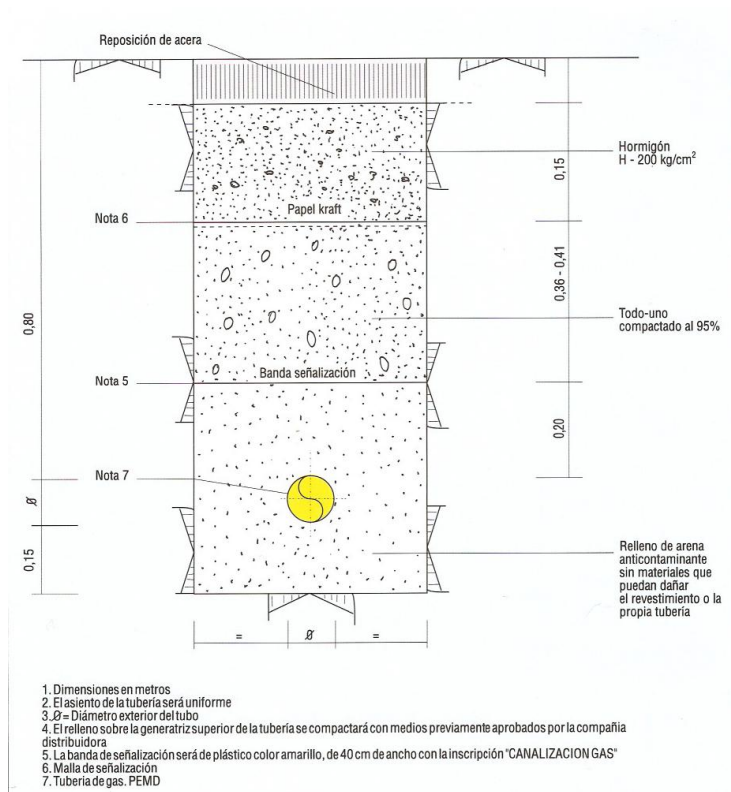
b Zanjas tipo. Zona urbana bajo acera
